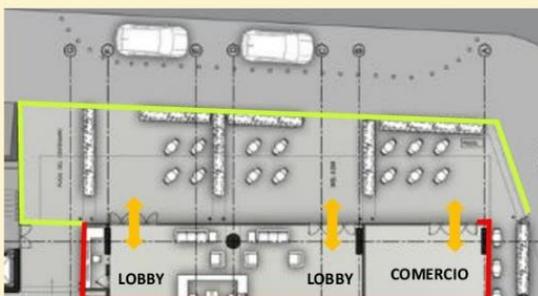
Planta del espacio al aire libre previo al ingreso del edificio Escala: 1/300 Fuente: www.archdaily.pe
